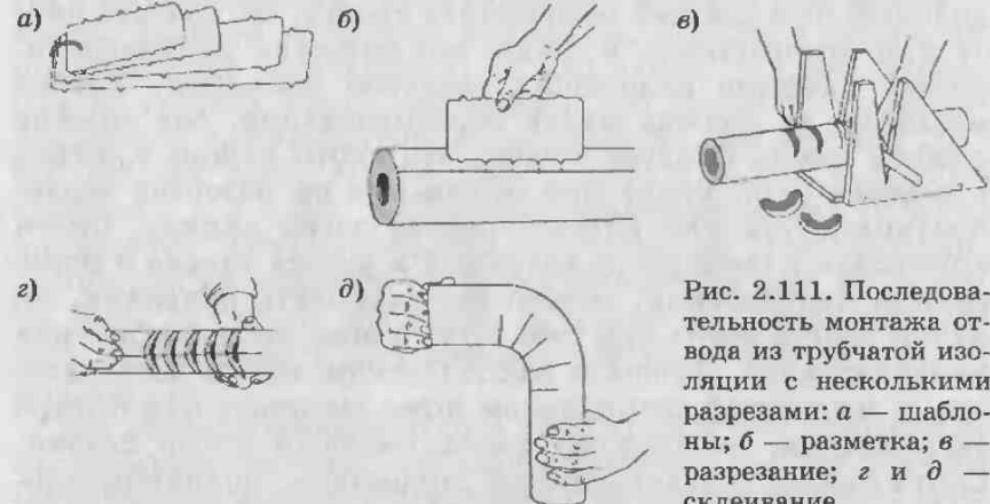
Последовательность монтажа отвода из трубчатой изоляции с несколькими разрезами: а — шаблоны; б — разметка; в — разрезание; г и д — склеивание
